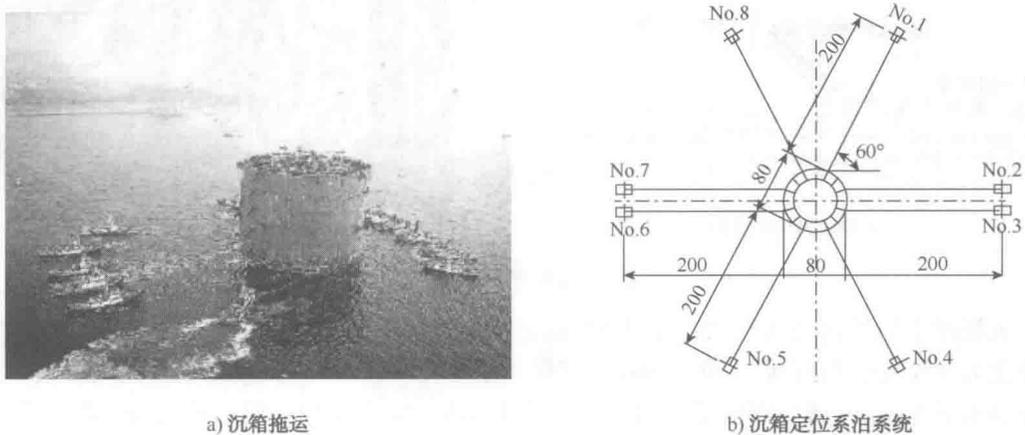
日本明石海峡大桥施工(尺寸单位:m)
